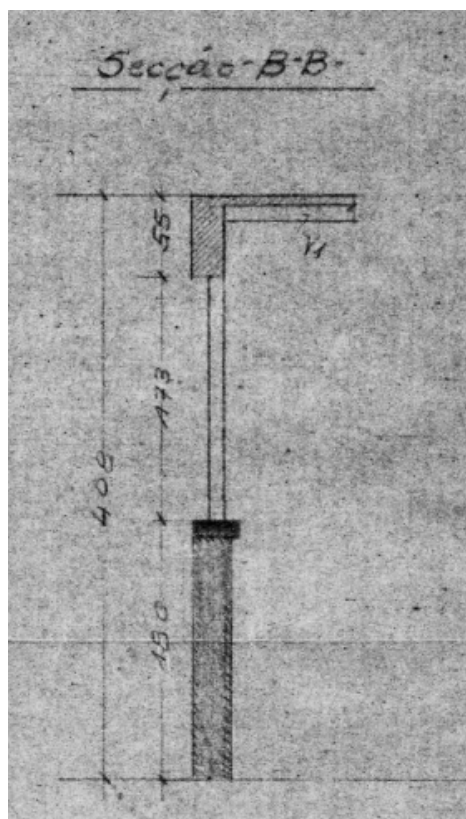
Detalhe da seção da recepção com pilares de seção variável e laje em grelha. Vigas utilizadas no projeto; a V14a e V14b são as vigas da administração e mostram em corte a variação de desenho.
